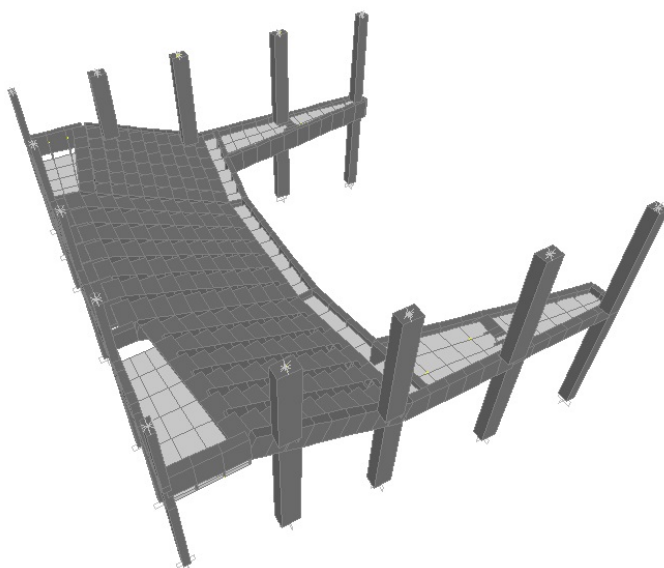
Vigas de Bancada da Solução Pré-Esforçada
